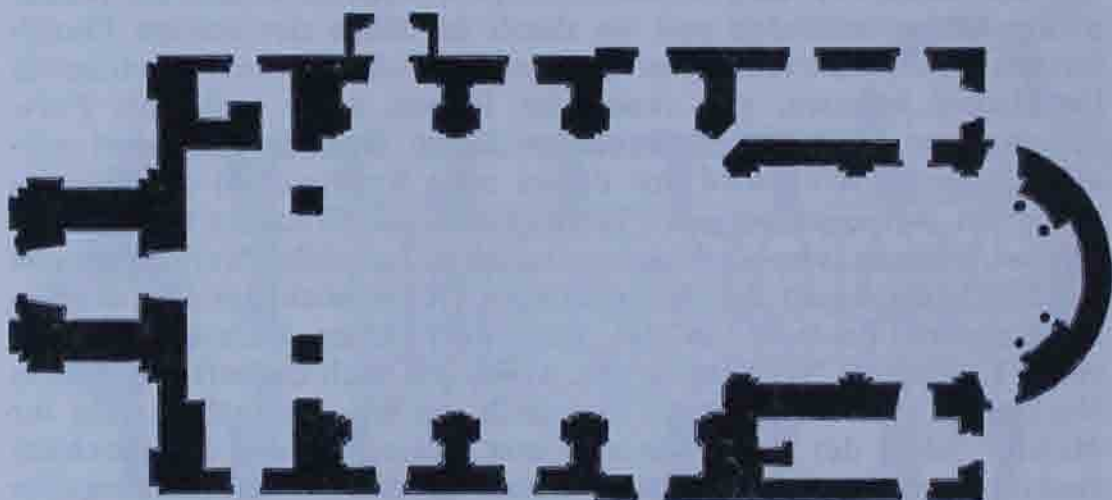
Loosdorf, Pfarrkirche; Grundriß.
